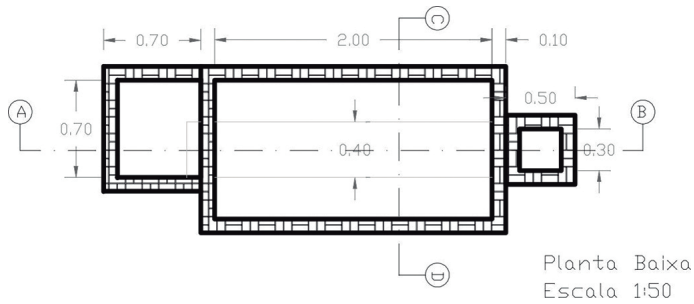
Planta baixa do secador a ar quente por convecção natural para a castanha-da-amazônia.
